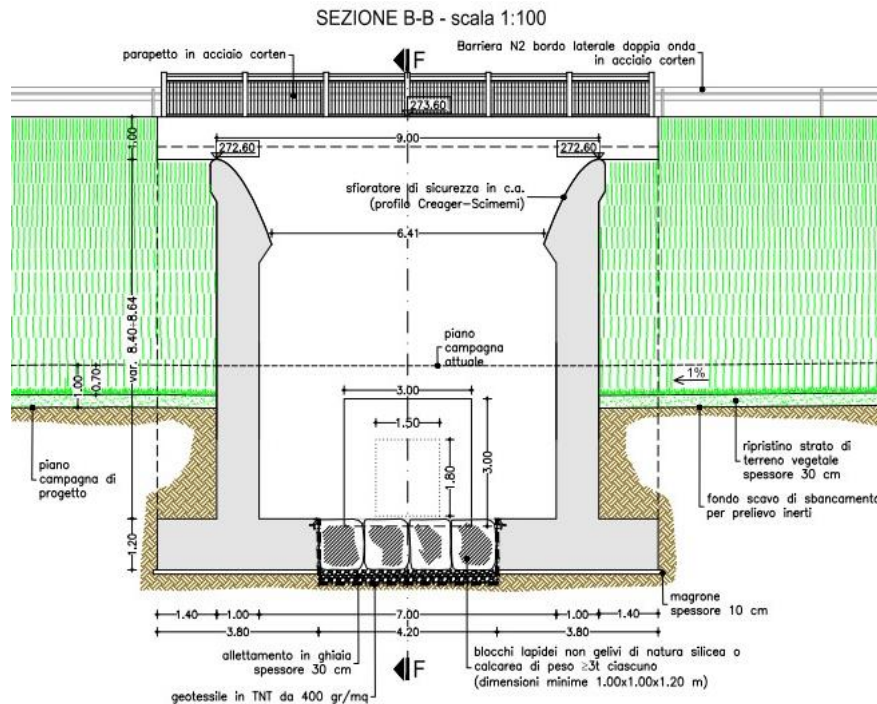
muro di chiusura del manufatto di regolazione e scarico con prospetto sul cunicolo d'ingresso dello scarico di fondo.
